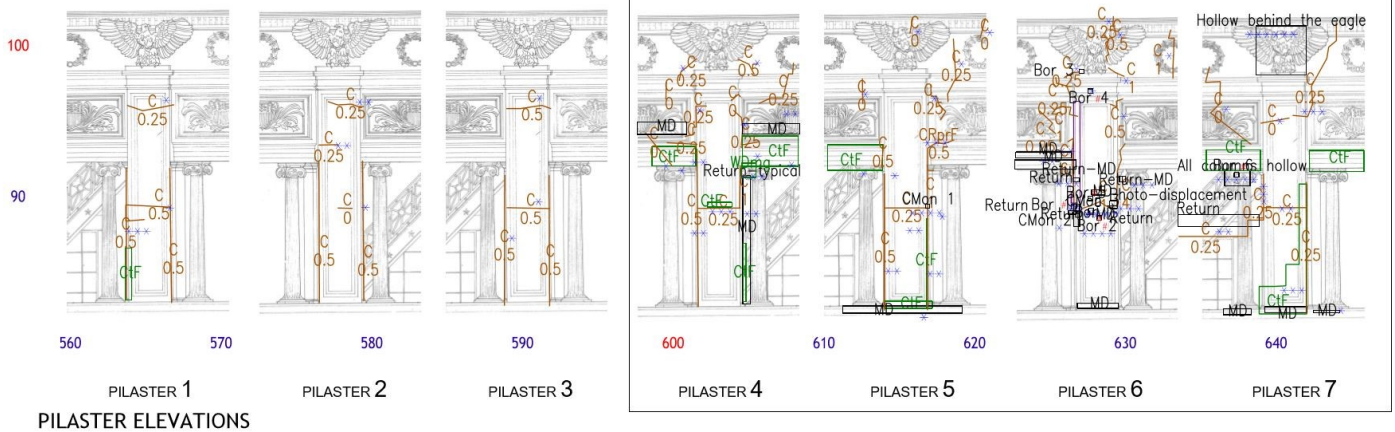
La figura muestra la nomenclatura de las pilastras, así como el plano TPAS donde claramente se observa un patrón en las grietas de las pilastras.
